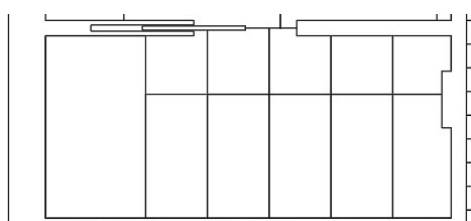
Desenho do pavimento das casas de banho. Fonte: Autora
